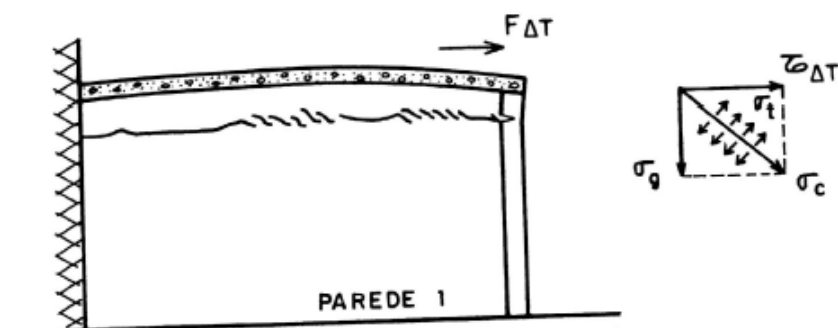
Trinca típica no topo da parede paralela ao comprimento da laje
